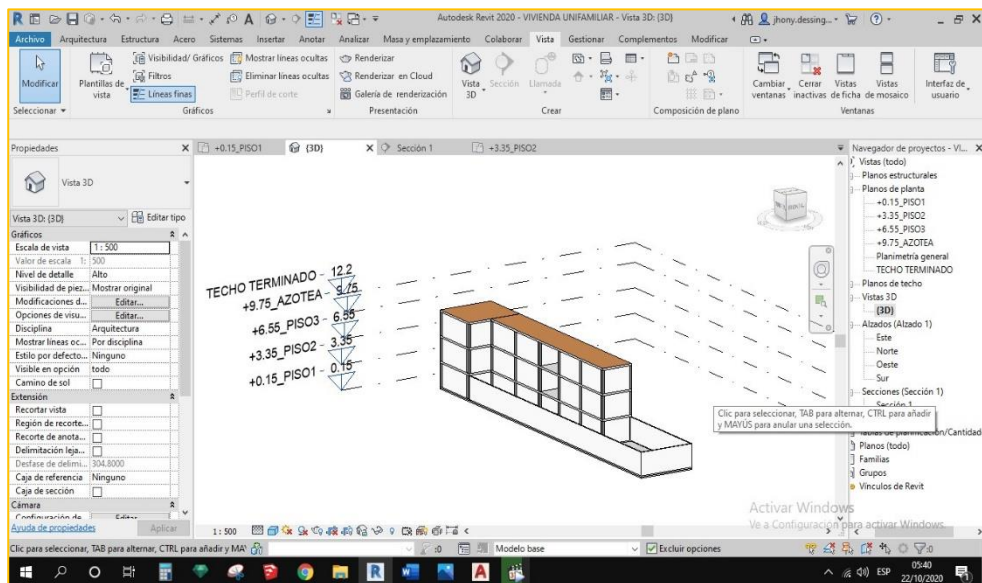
Vista en isométrico de muros, pilares arquitectónicos y losa aligerada en los tres niveles.
